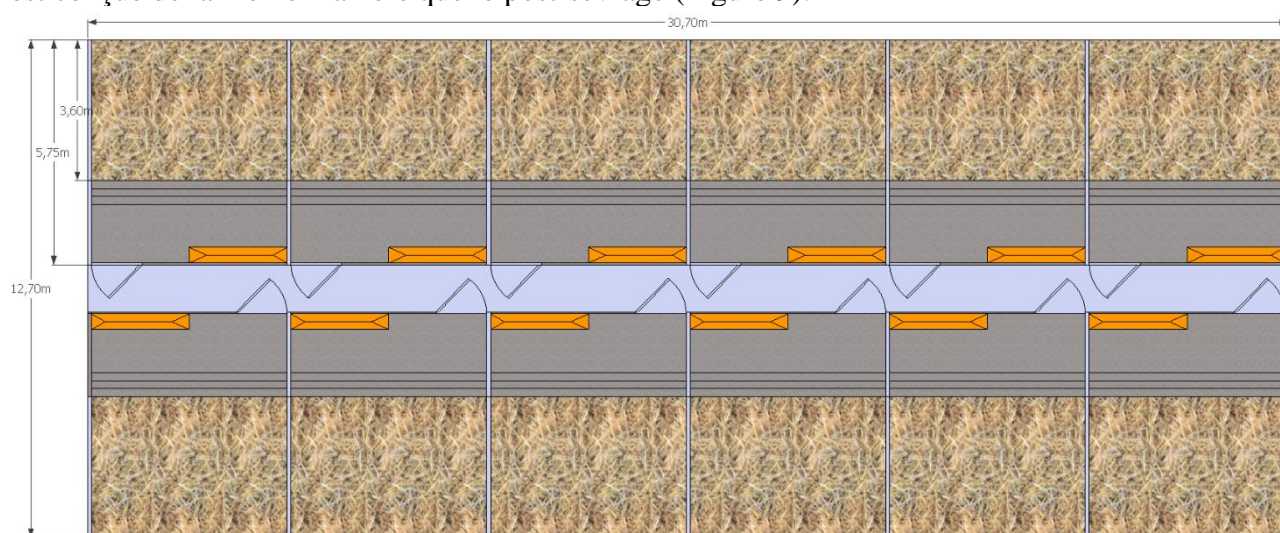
Exemple d'une salle d'engraissement sur litière accumulée (orange = nourrisseur et gris = dalle béton)
